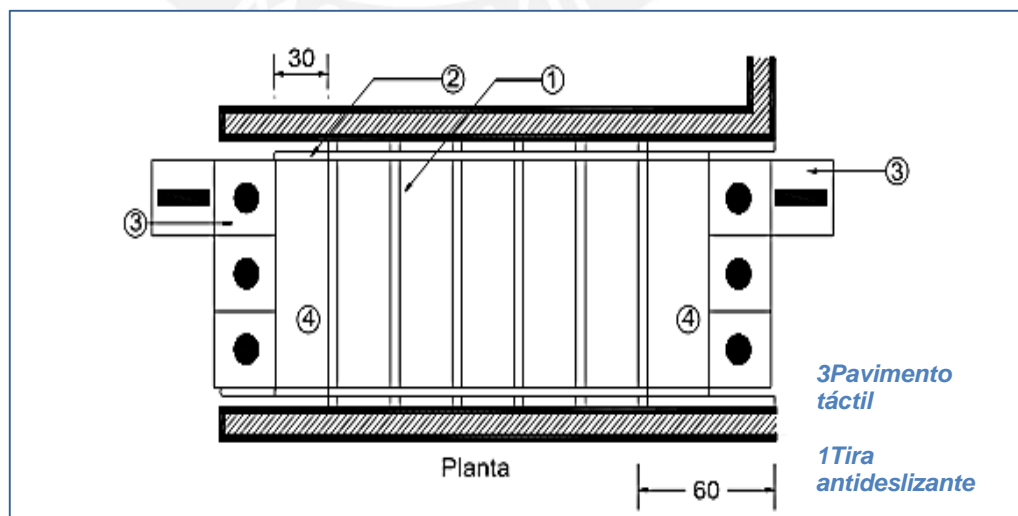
Vista en planta de diseño de escalera. Fuente: SEDUVI, 2012.
